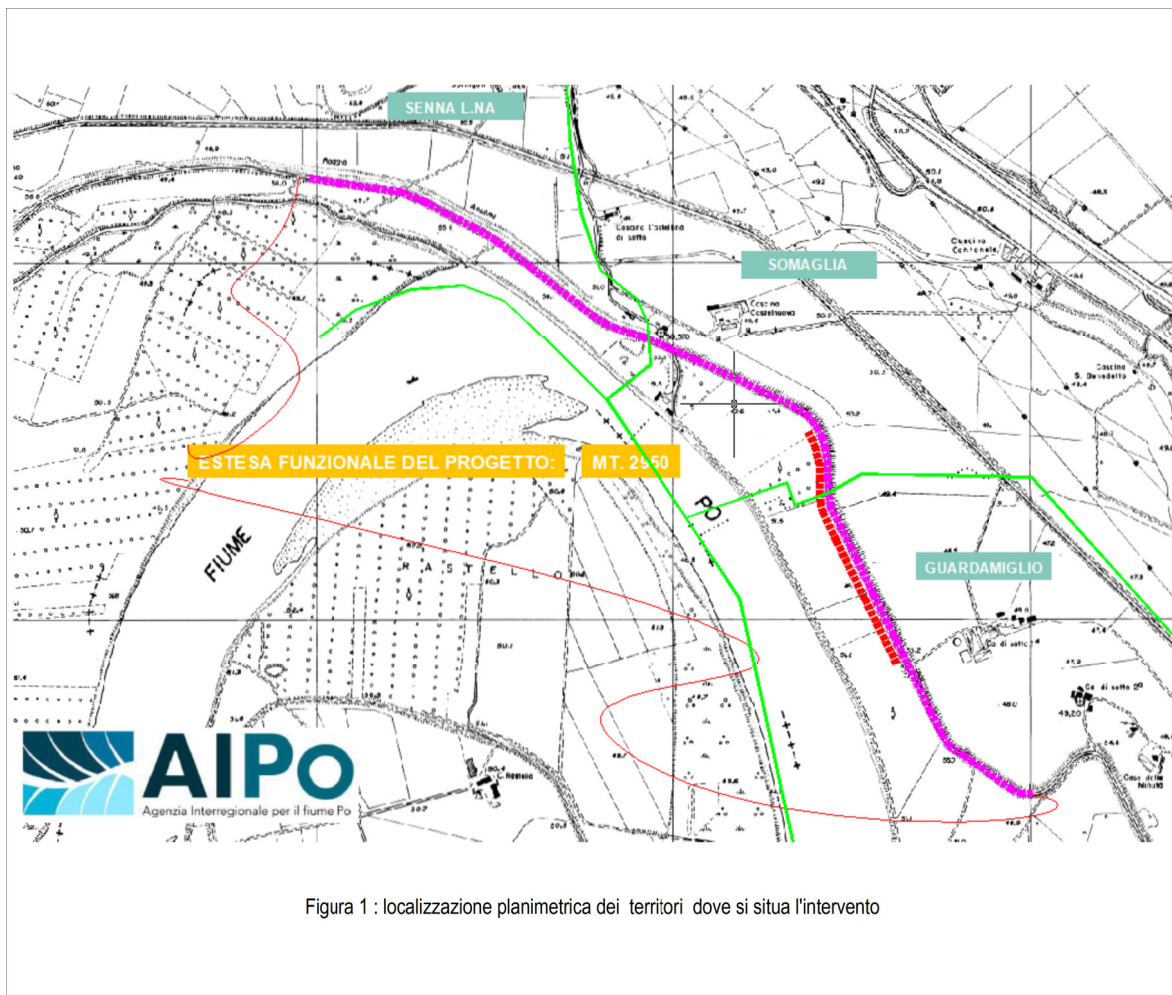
localizzazione planimetrica dei territori dove si situa l'intervento
